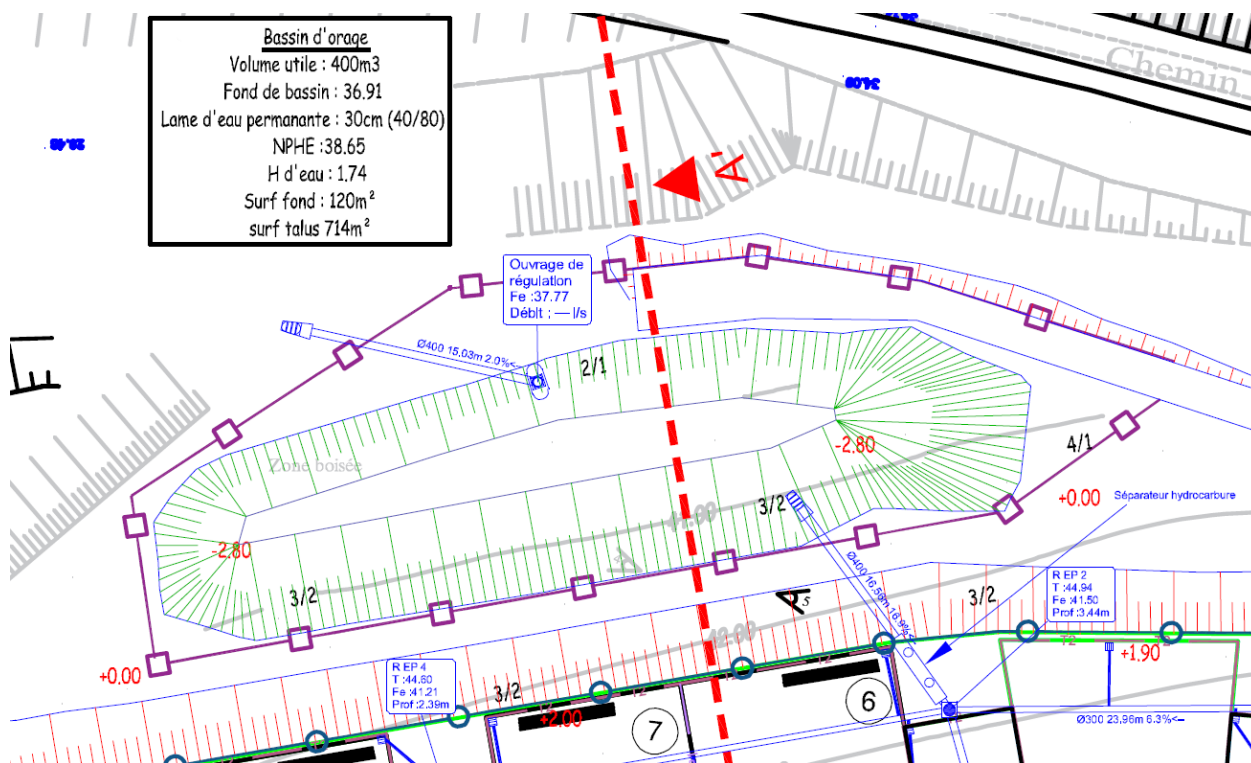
Plan d'aménagement du bassin de régulation des eaux pluviales
